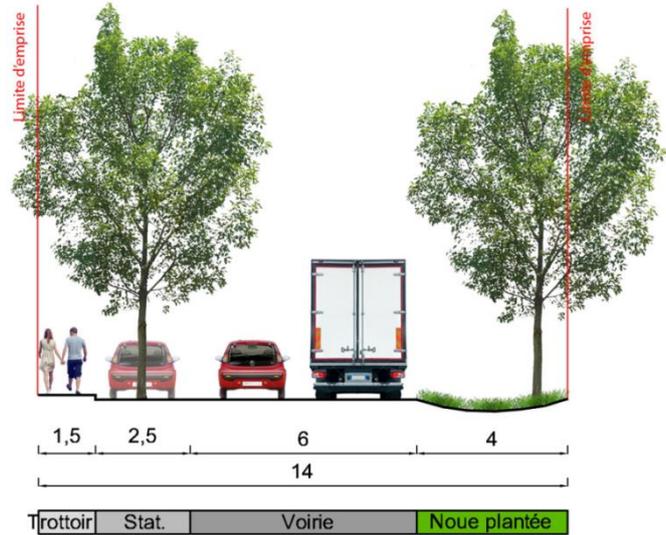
Profil type des voies tertiaires : profil 3 : avec stationnement
